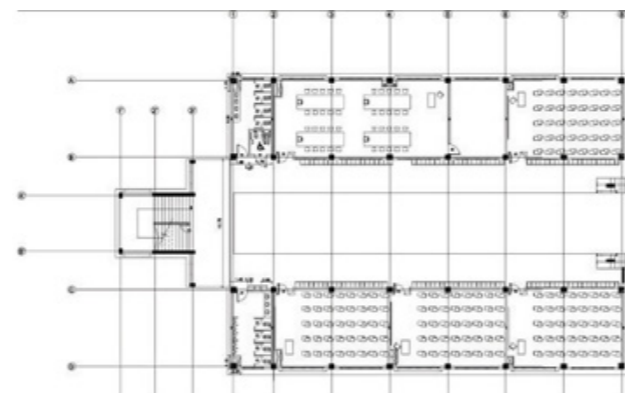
Planta baja del aula. Fuente: MINEDUC.
